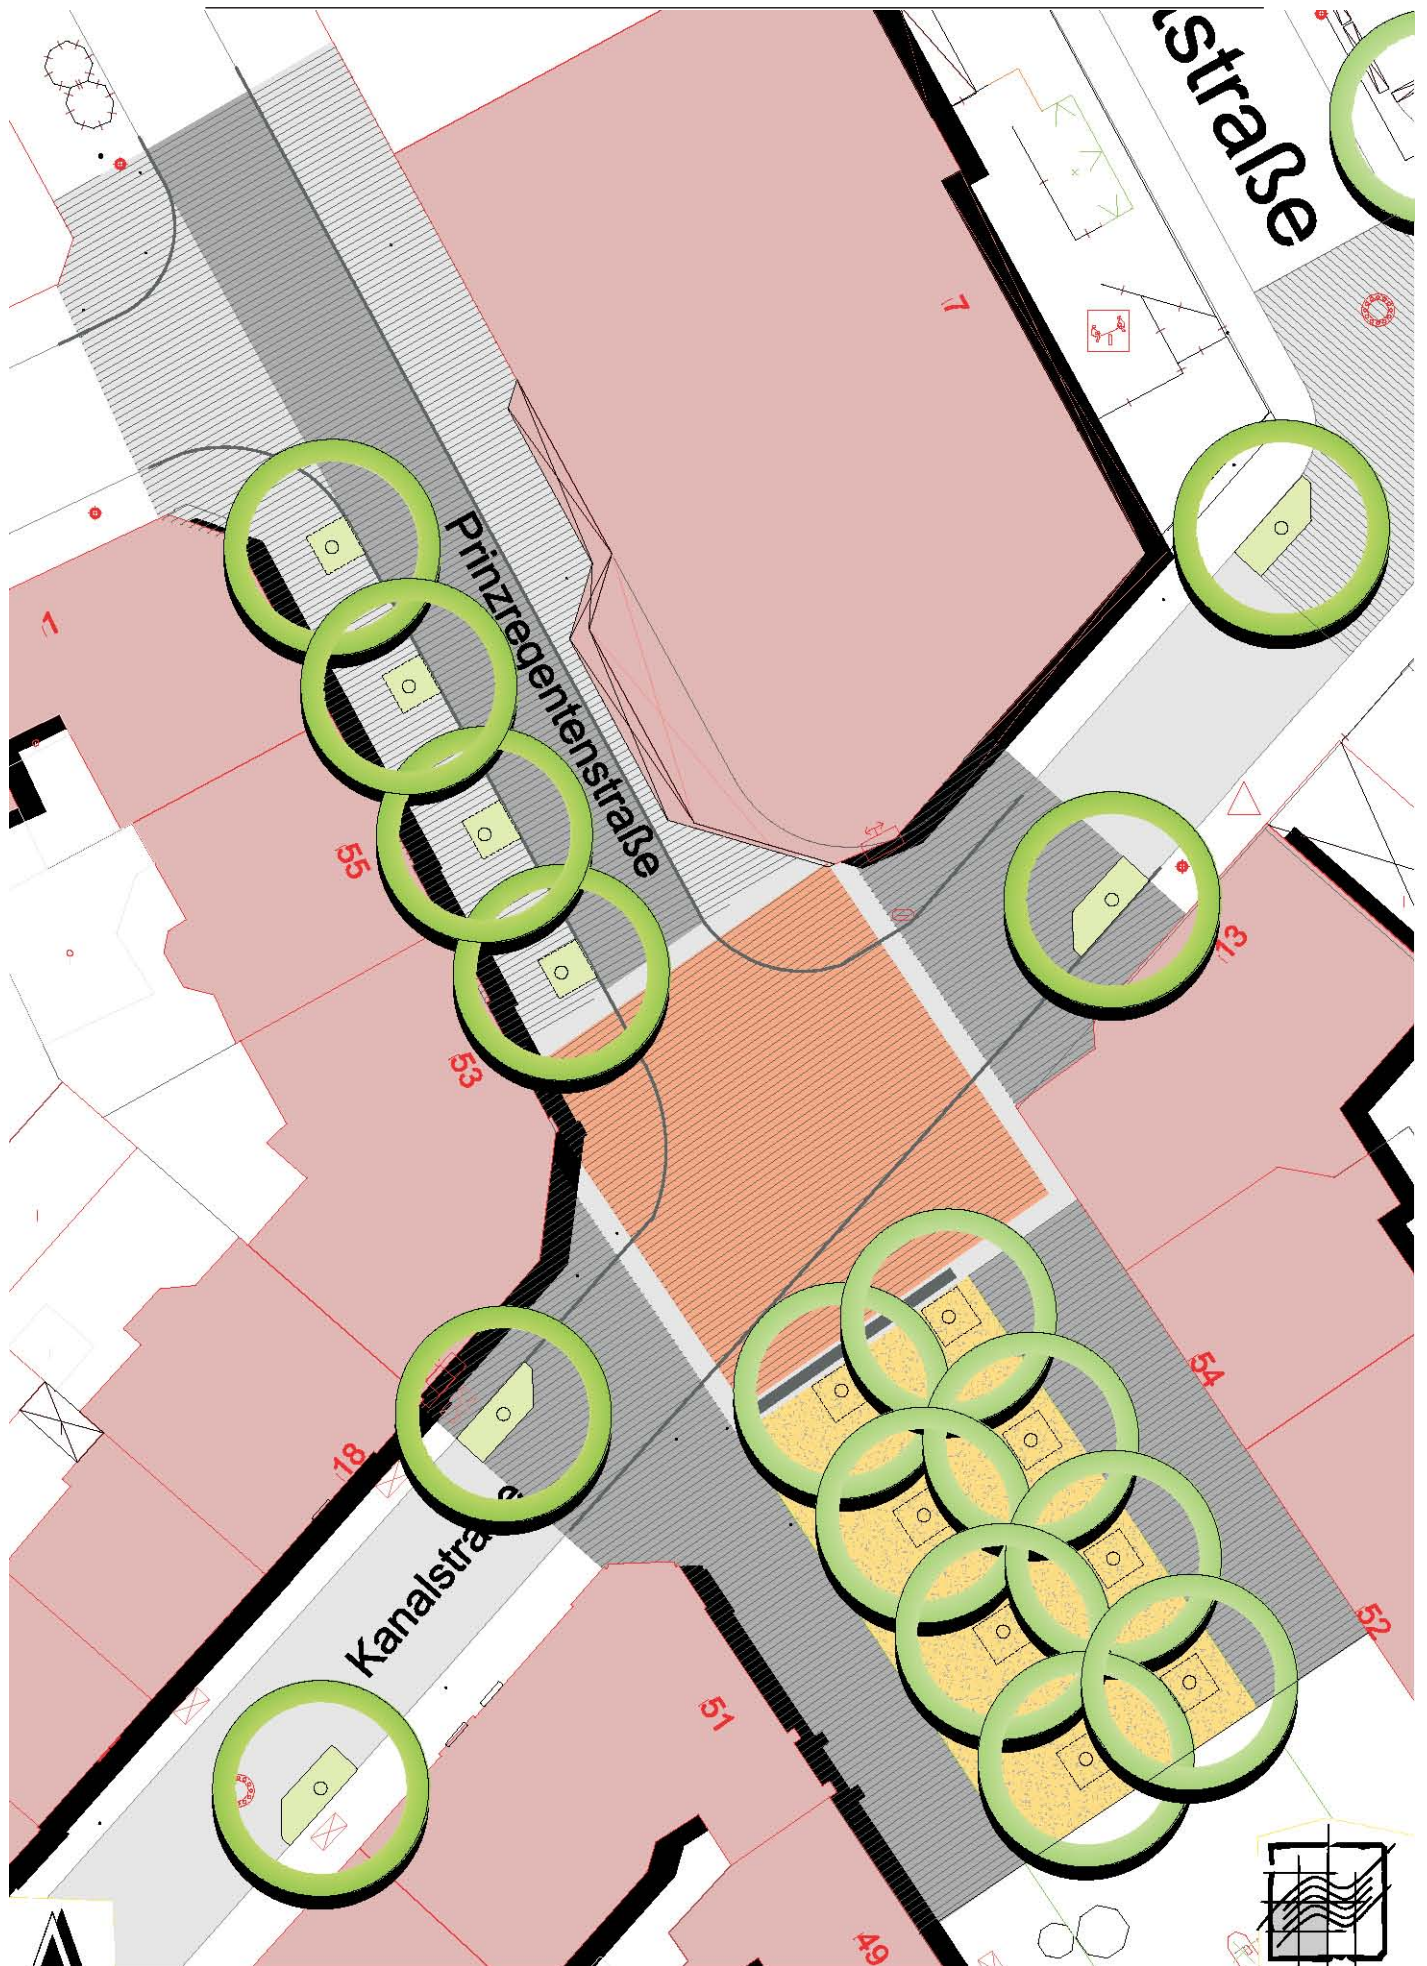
Bereich Kanalstraße / Prinzregentenstraße
